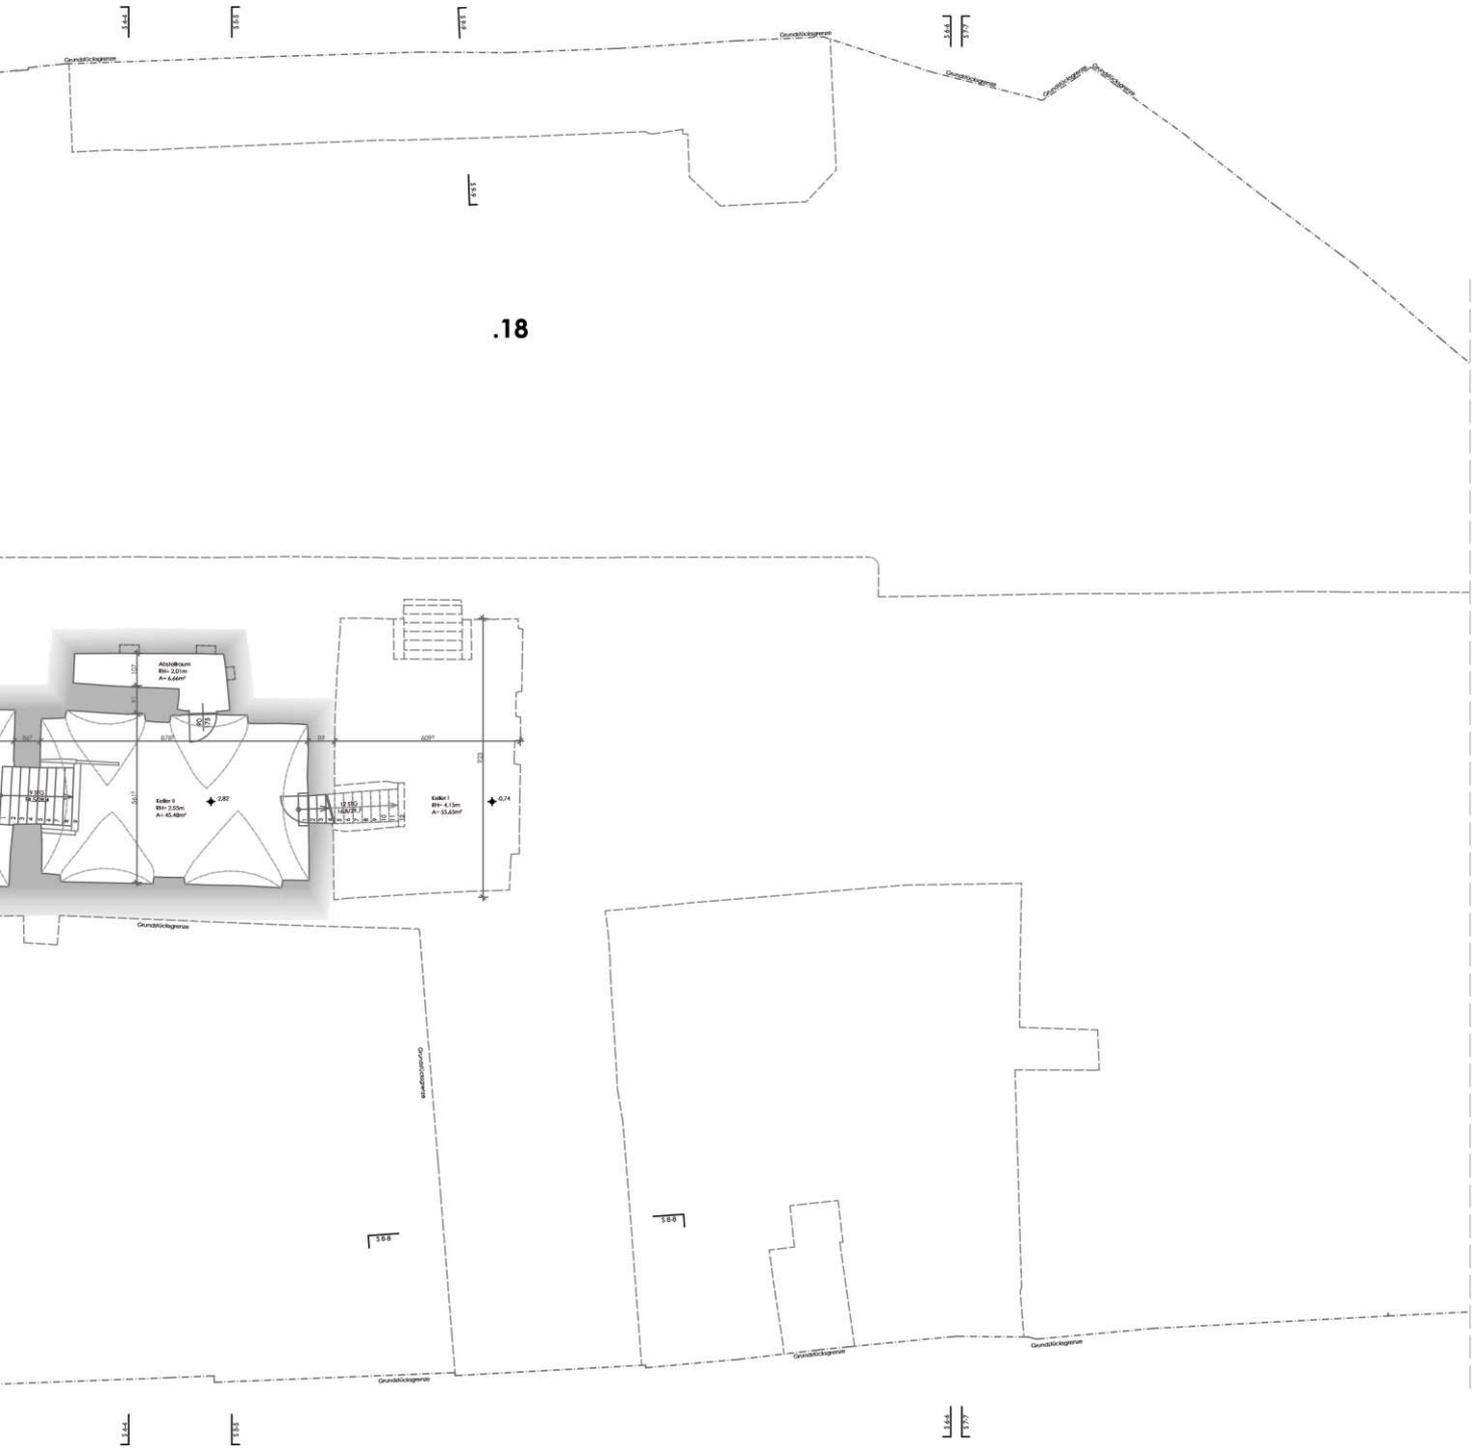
Bestandsplan Grundriss Kellergeschoss M 1:250
